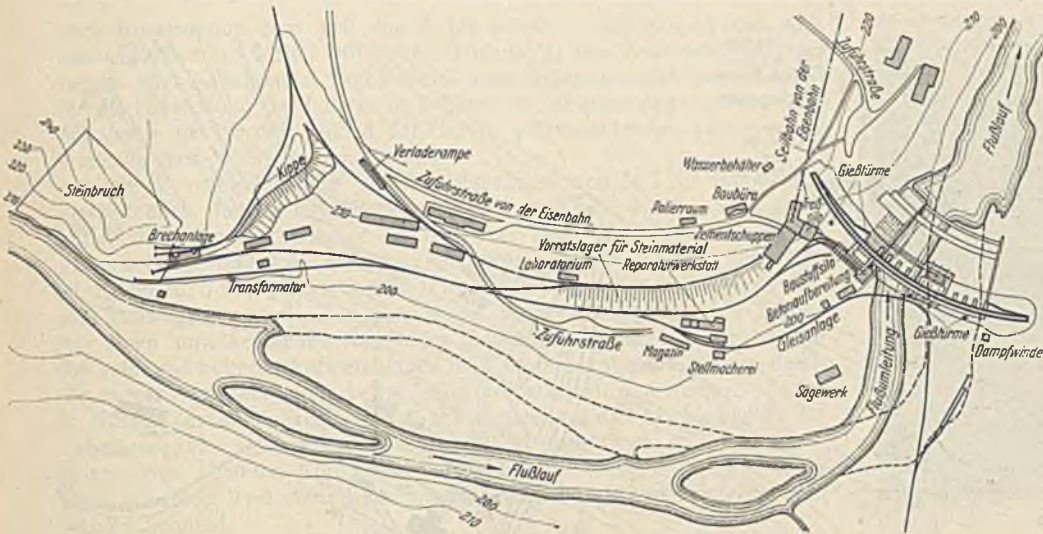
Kriebsteinsperre. Baustelleneinrichtung. Lageplan.
